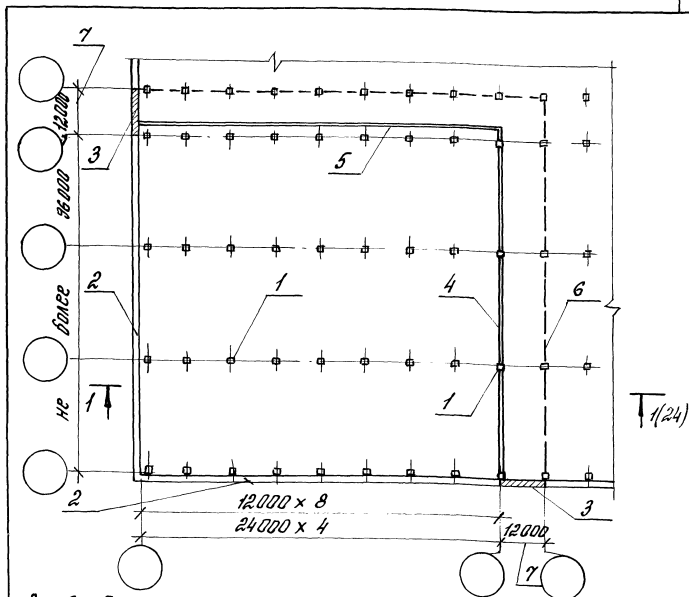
Пример расположения противопожарных перегородок и диафрагм в составе противопожарного пояса, разделяющего конструкции покрытия и стен из горючих и трудногорючих материалов
